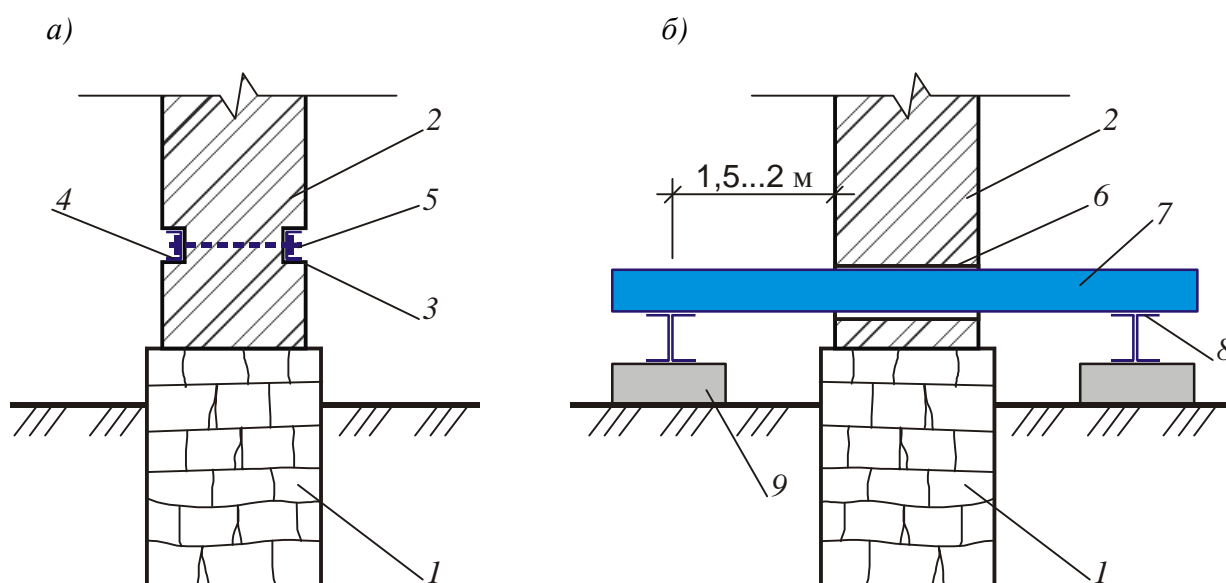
Полная разгрузка фундаментов с помощью:
